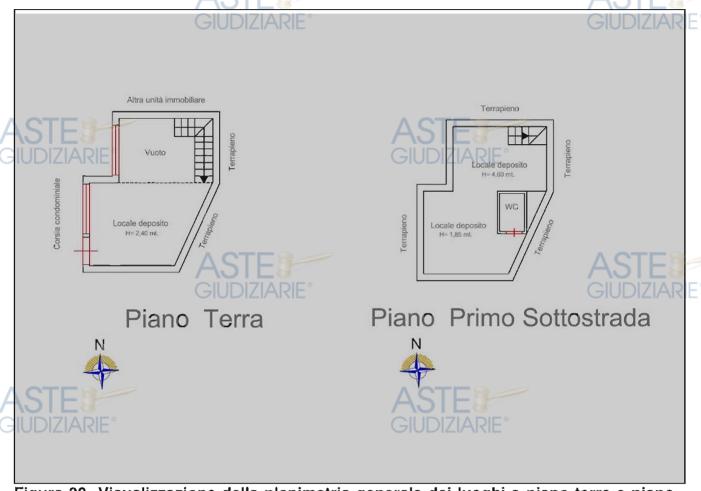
Visualizzazione della planimetria generale dei luoghi a piano terra e piano primo sottostrada
